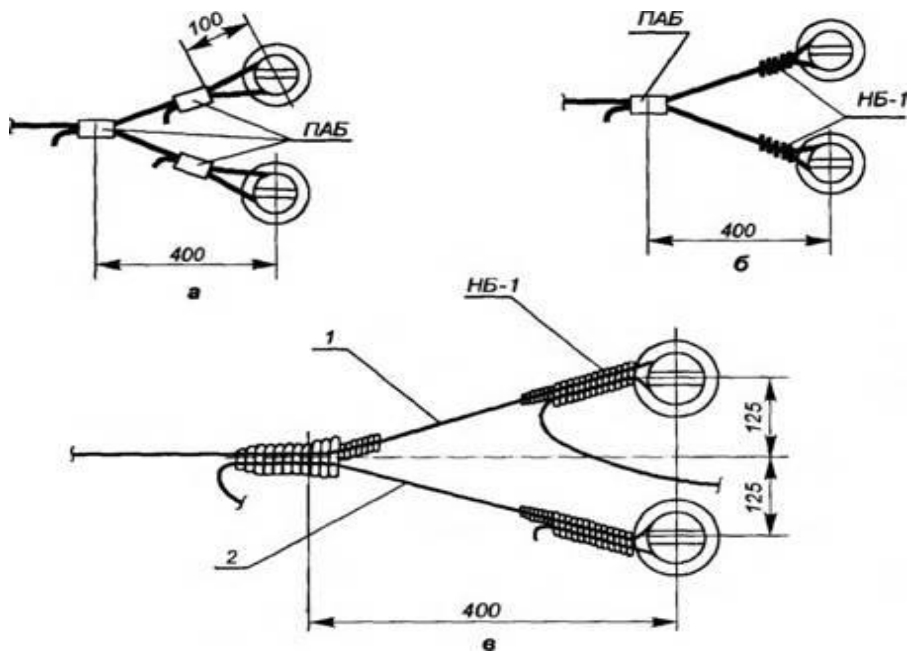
Двойное анкерное крепление провода на штыревых изоляторах анкерной опоры:
